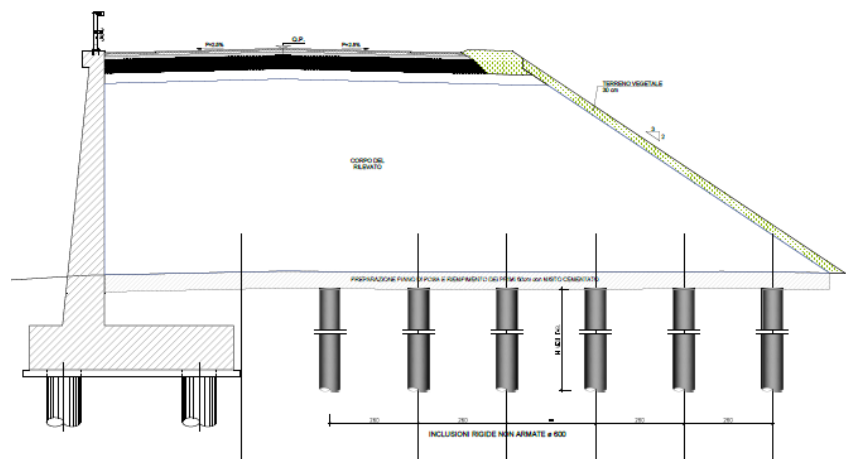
Sezione tipo del rilevato di approccio spalla A con inclusioni rigide
